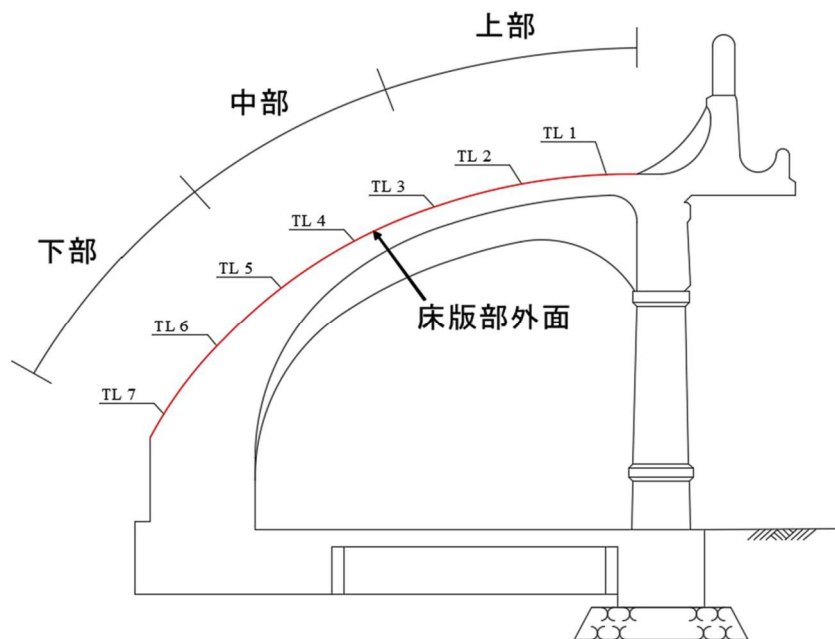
鉄筋かぶりと自然電位の測定位置（断面図）
